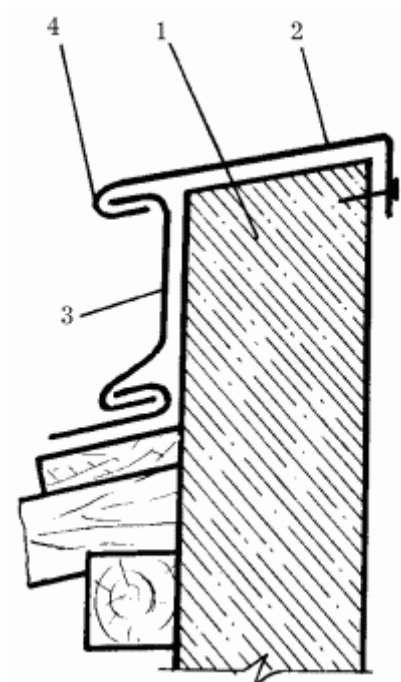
Покрытие парапета: 1 – парапет; 2 – стальное покрытие; 3 – фартук; 4 – капельник.
